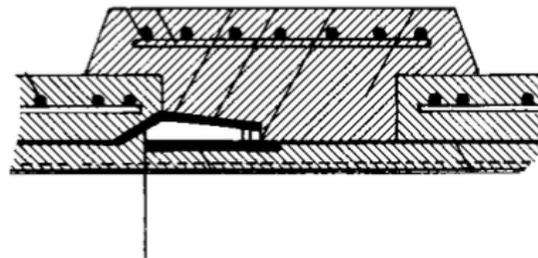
Unión soldada para tuberías de hormigón camisa chapa
